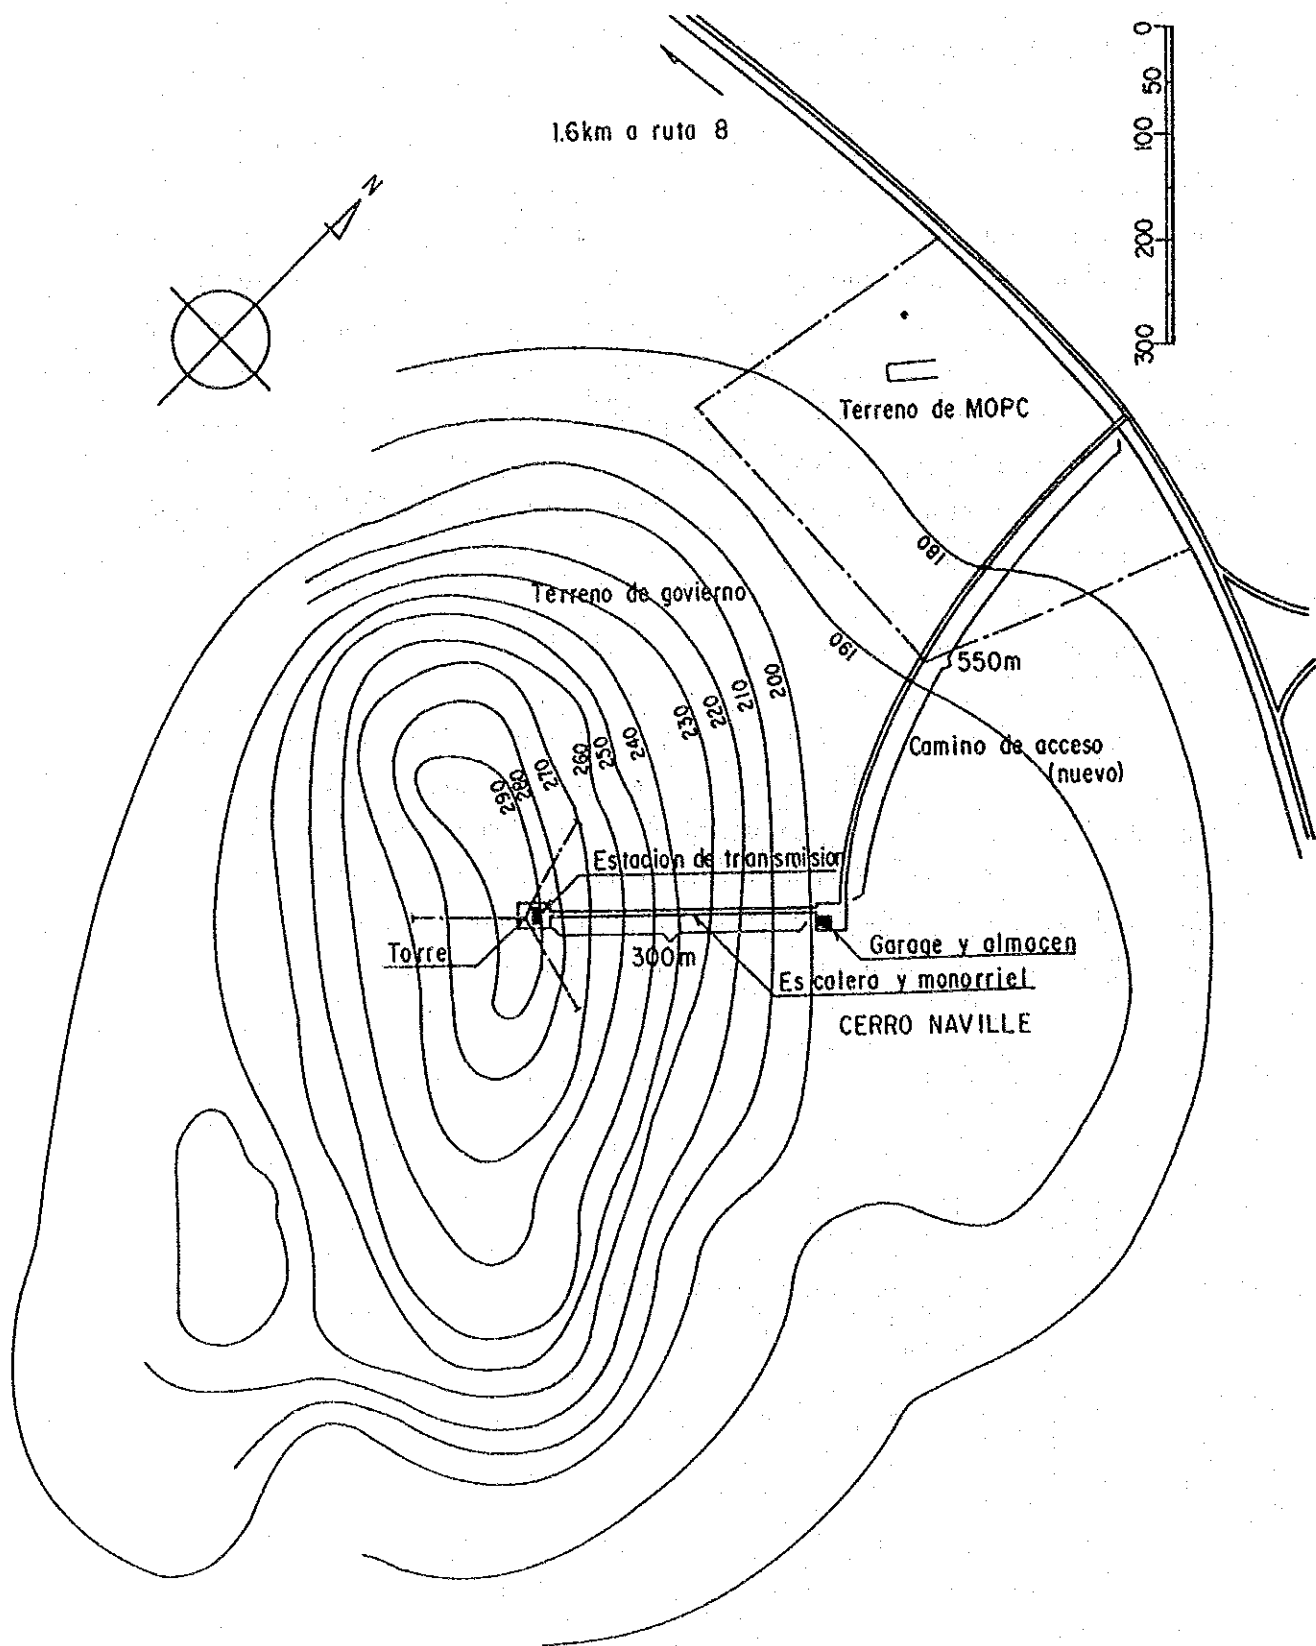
Plano de Disposición de la Estación Teledifusión en Villarrica
